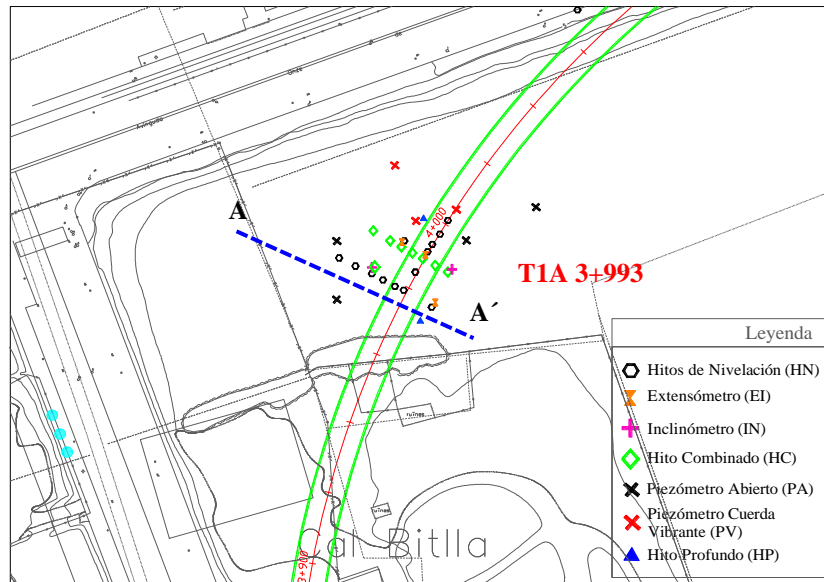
23. Situación en planta del túnel y la sección de control T1A PK 3+993
